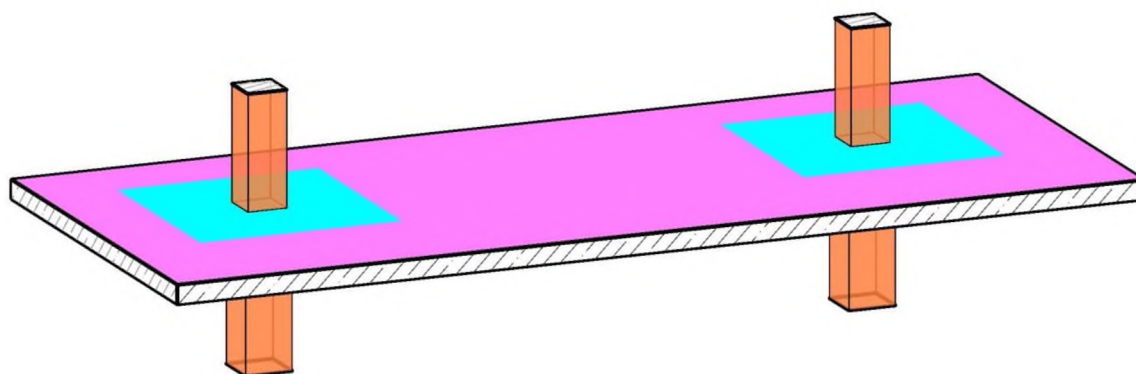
Общий 3D вид плиты перекрытия в виде конструктивных элементов
